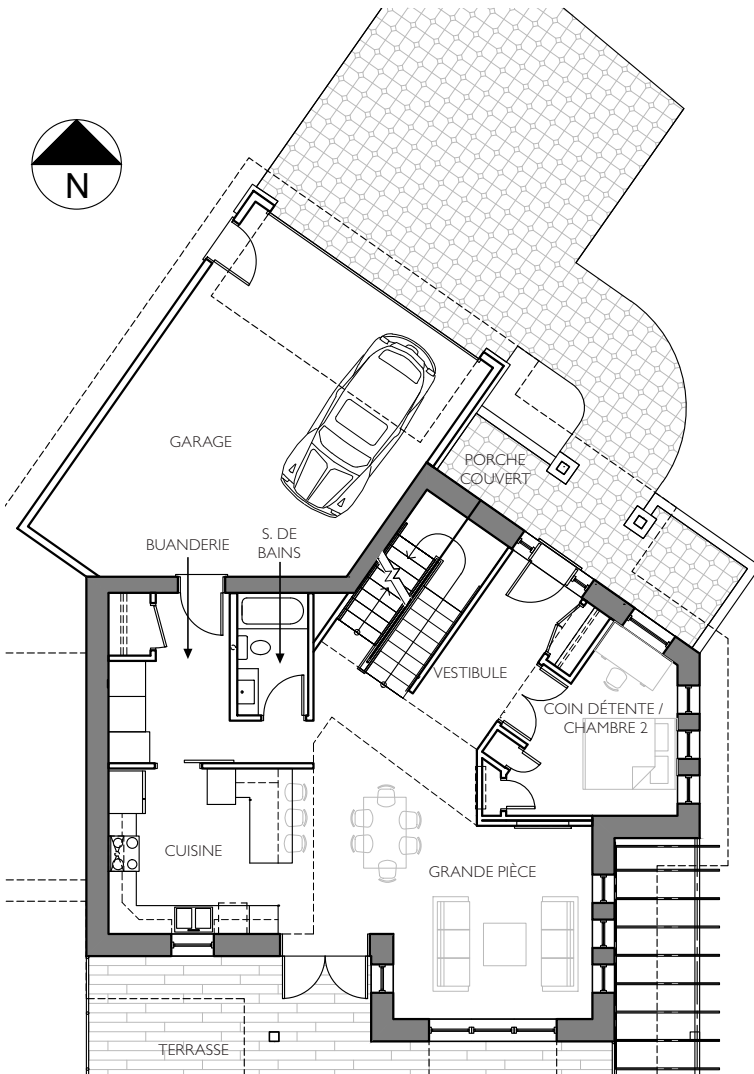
Plan du rez-de-chaussée de la Green Dream Home
